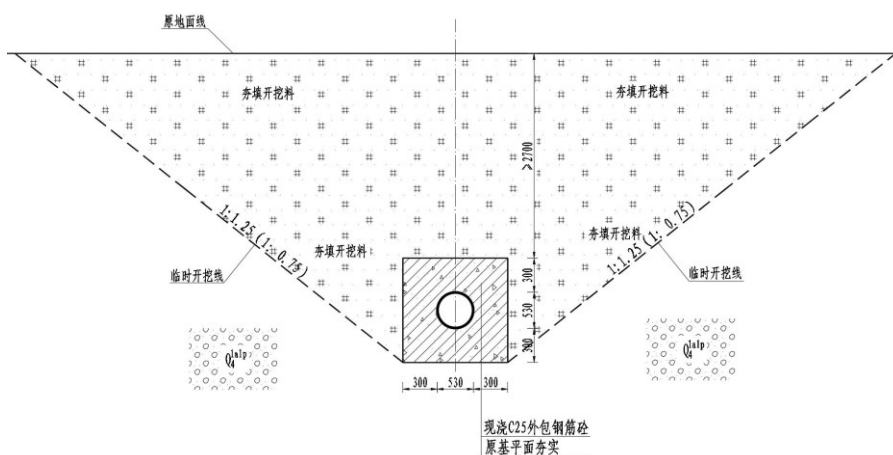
穿河（禹河）段管道基础横断面图
